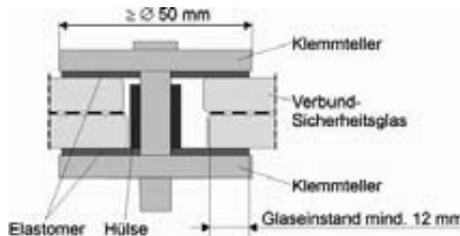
Prinzipskizze Querschnitt Tellerhalter
